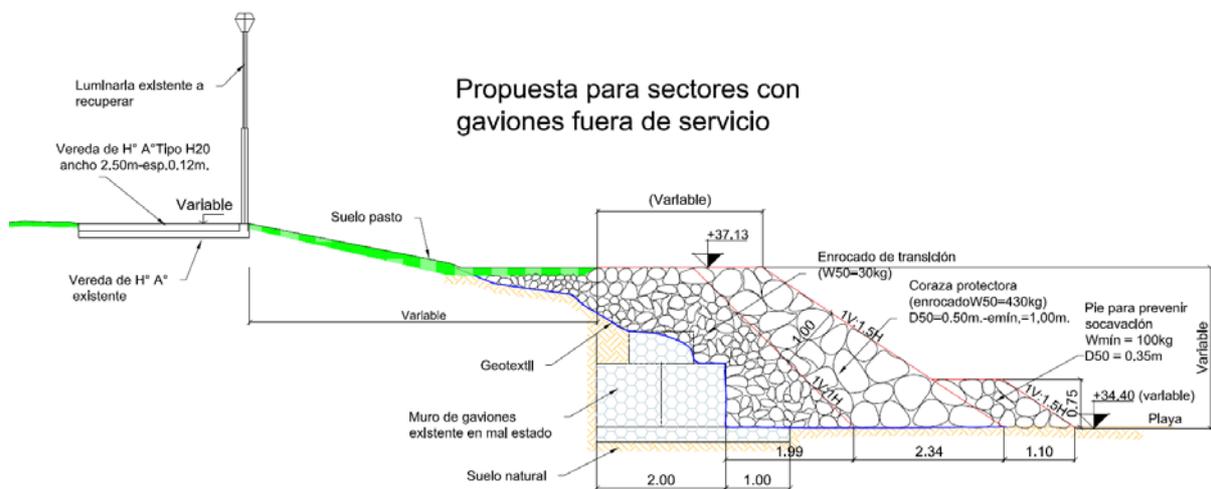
Perfil transversal tipo en Sectores con Gaviones fuera de servicio.
